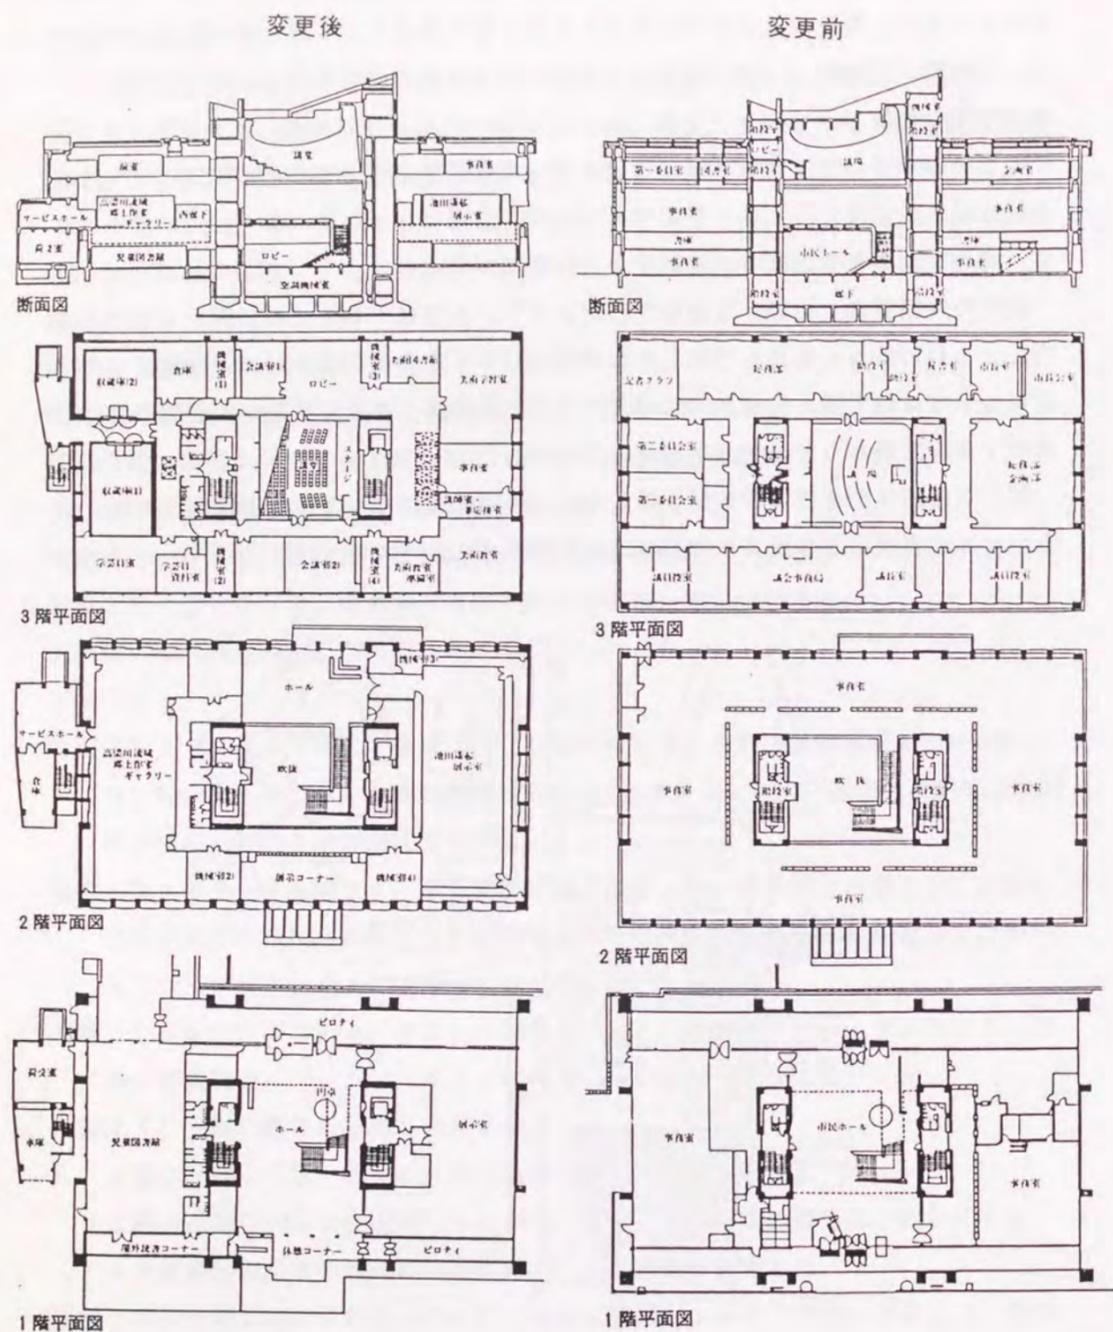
<11>倉敷展示美術館(旧市庁舎)平面図
